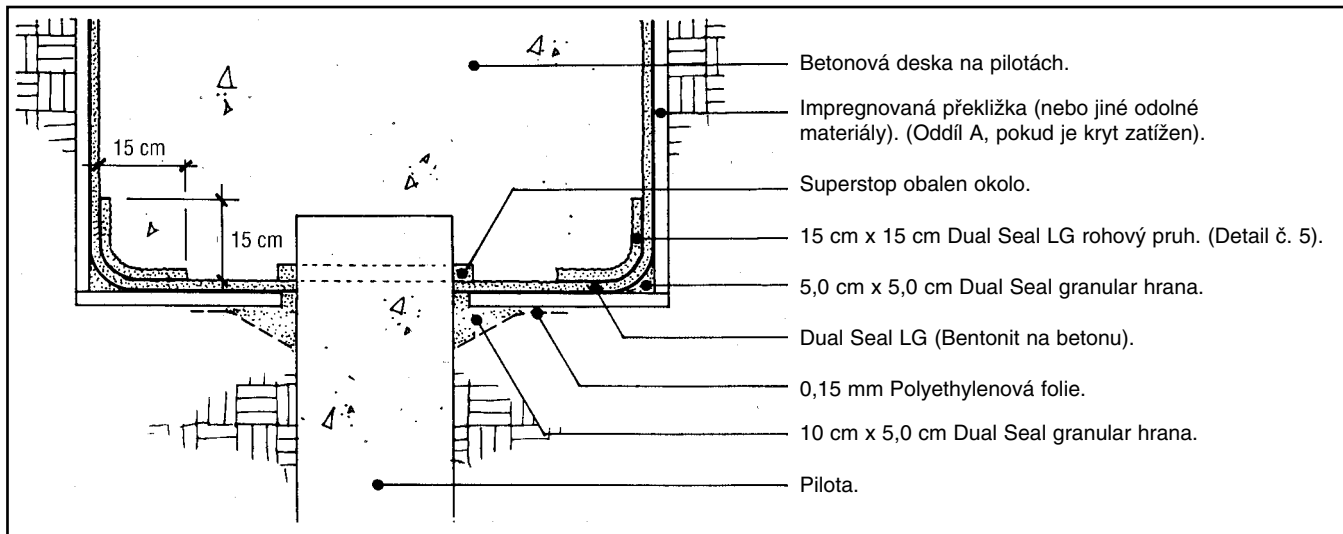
Průnik betonovou podlahou. (následně dobetonováváný).
